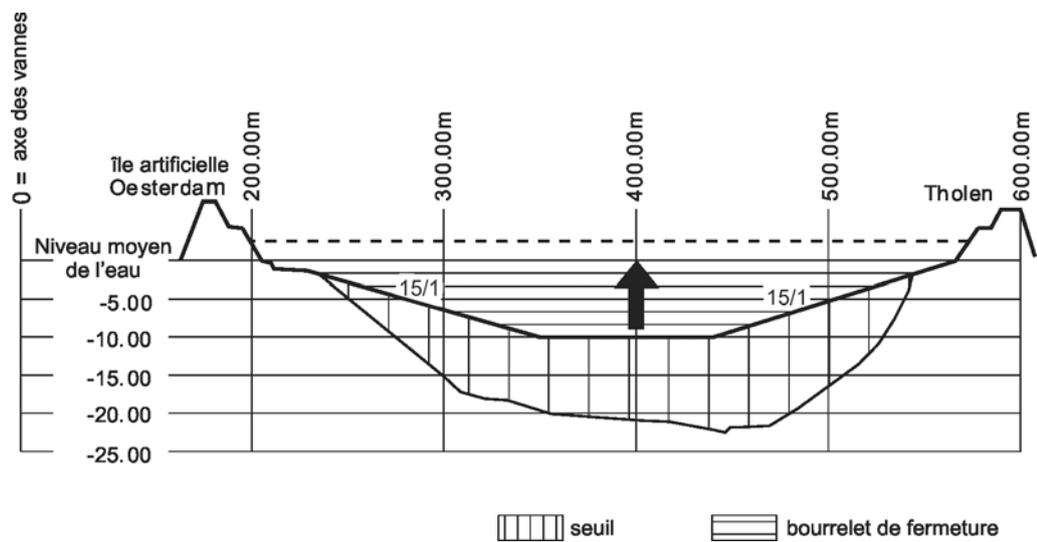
Coupe du barrage de Tholense Gat au niveau de l'axe de fermeture après construction du seuil
